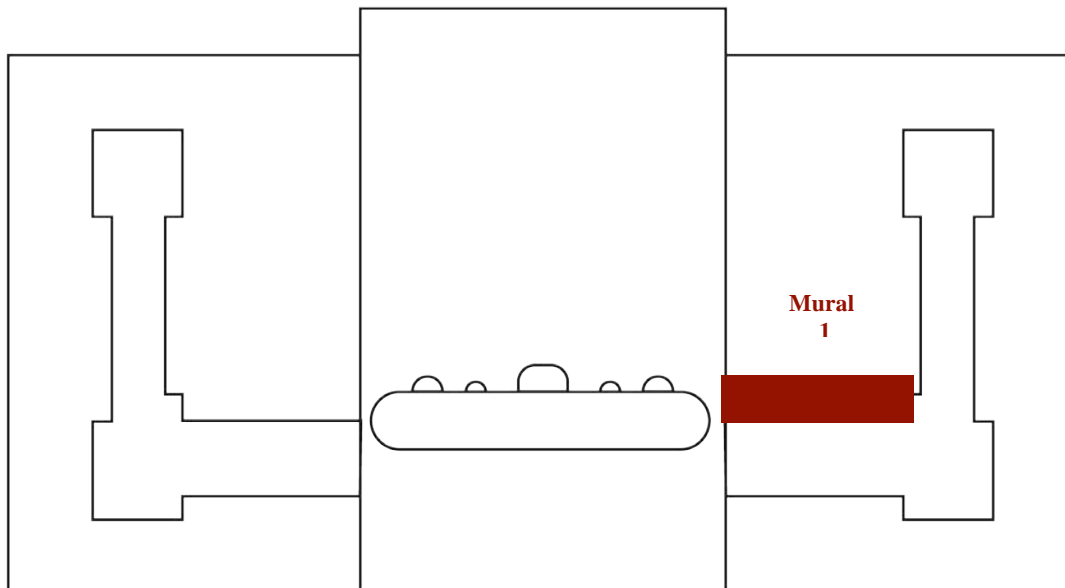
Mural 1: Mujer preñada. Planta del adoratorio.
